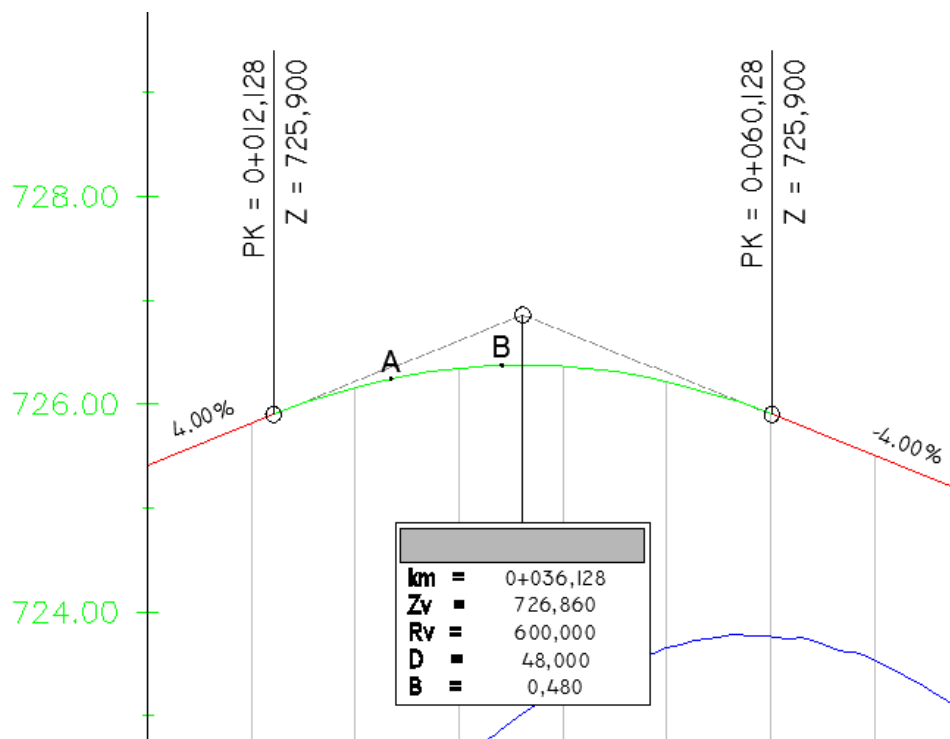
Perfil Longitudinal da rotunda B – Intersecção com o ramo B
